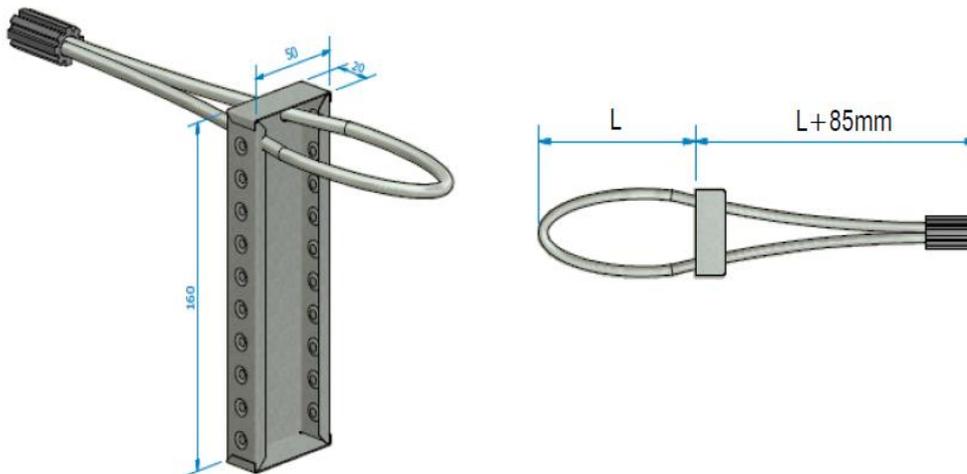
Dimensiones del Loop-100 sobre la pieza
